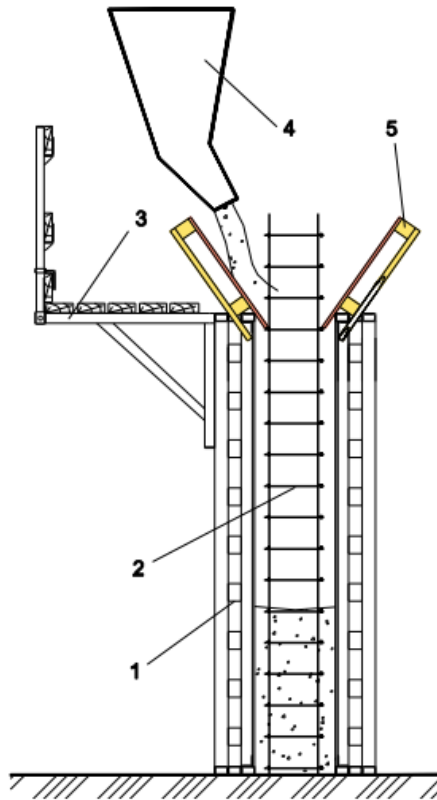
Схема укладки бетонной смеси в опалубку способом «кран — бадья»:
